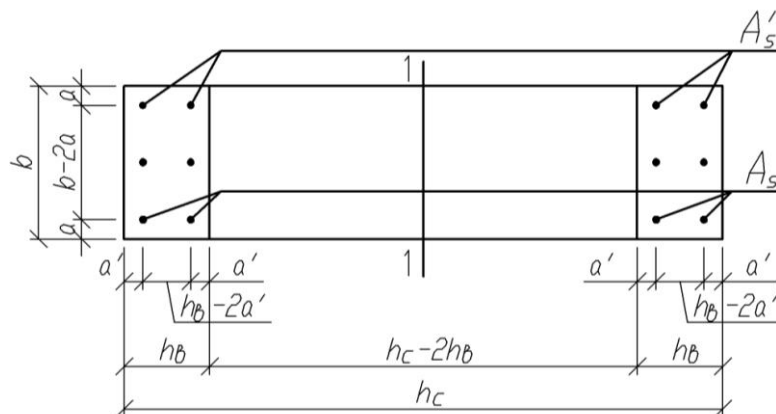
К расчету подкрановой части колонны из плоскости поперечной рамы
